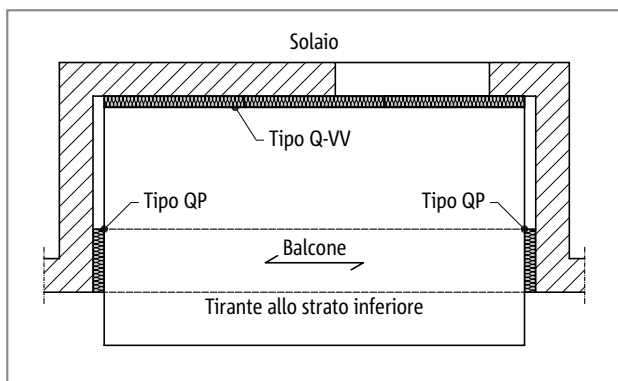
Schöck Isokorb® tipo Q-VV e QP, loggia con appoggio su tre lati
